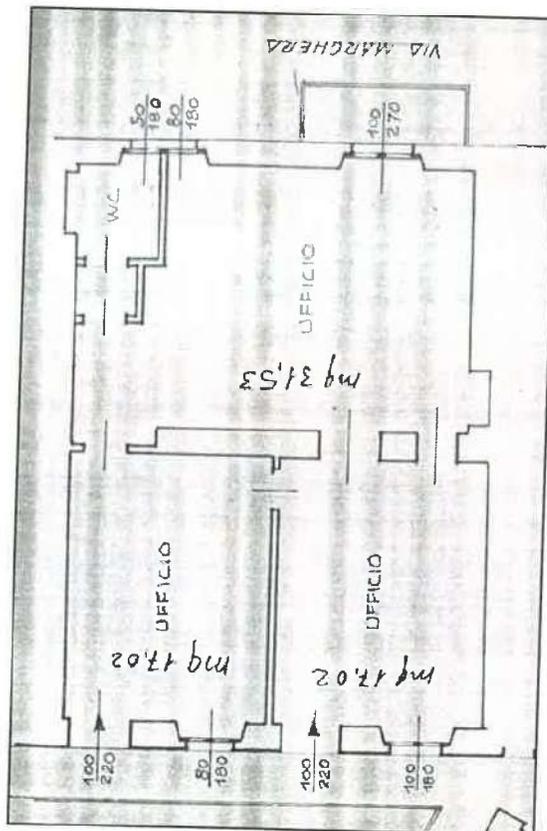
Planimetria allegata a C.E. in sanatoria del 1.10.1996
